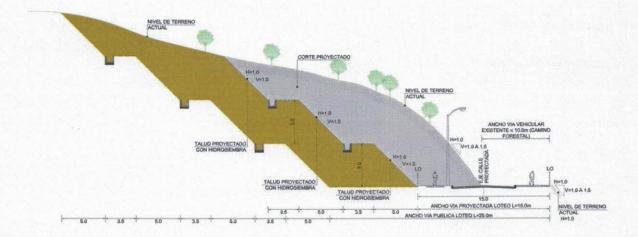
corte esquemático de los volúmenes de terreno a desplazar para construir una vía de 25 mts de ancho en terreno con pendiente similar al sector en que se emplaza vía Camino Los Españoles basado en información topográfica del terreno.
